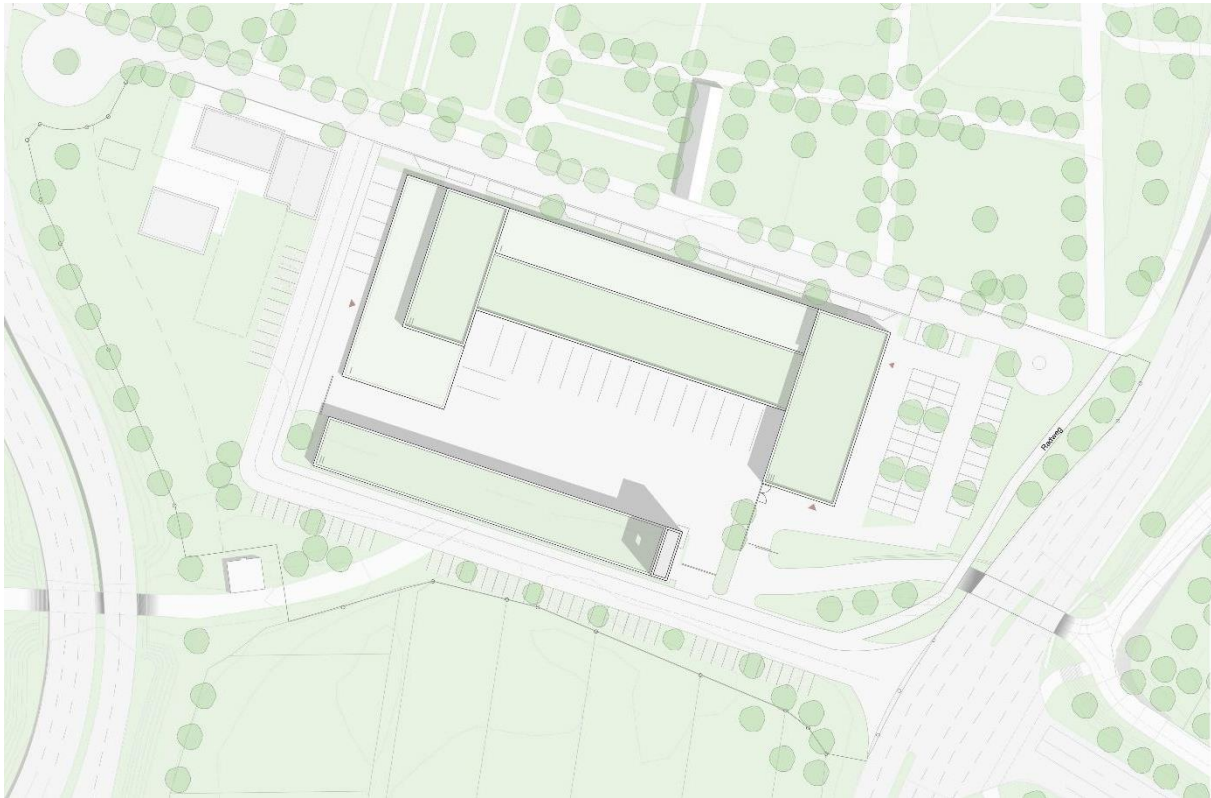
Lageplan Hochbauplanung kplanAG vom 26.03.2026 (Vorplanung)
